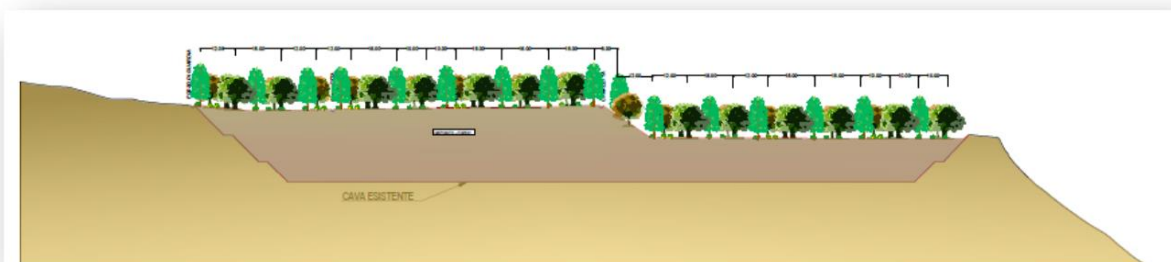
Opere a verde – Sezione di progetto deposito di Forch.
